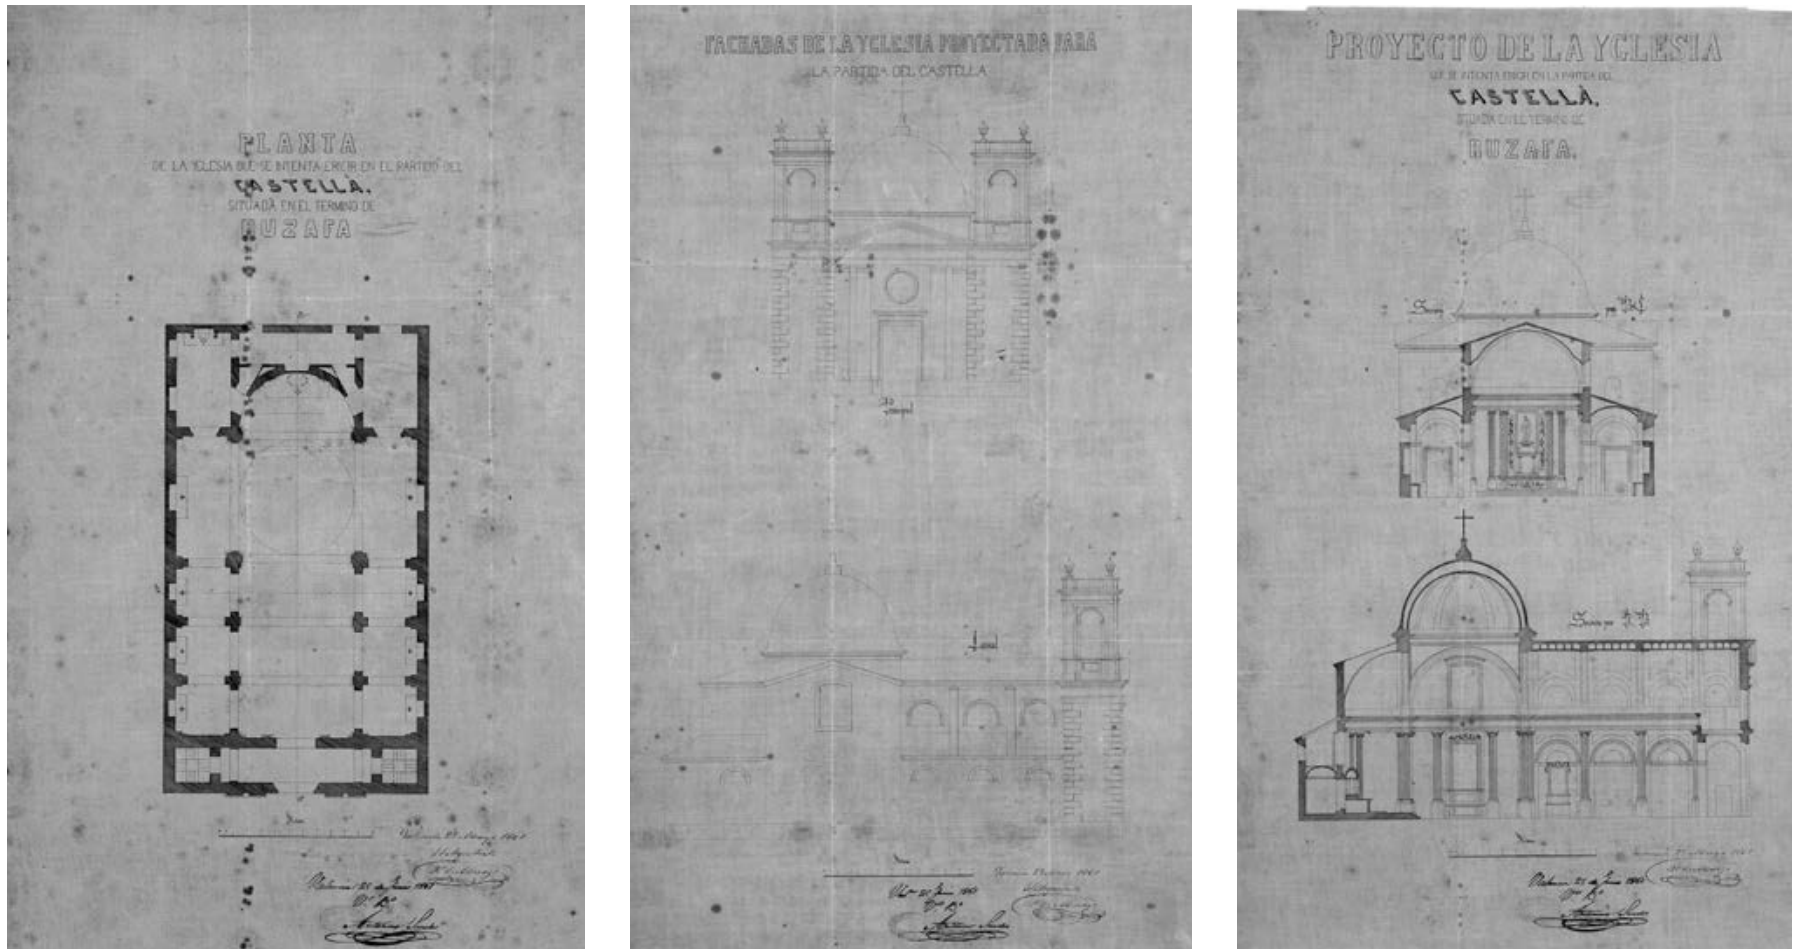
,163 y 164. Planta, alzado y sección del proyecto de Vicente Constantino Marzo de 1861 para la construcción de la Iglesia del Castellá.
